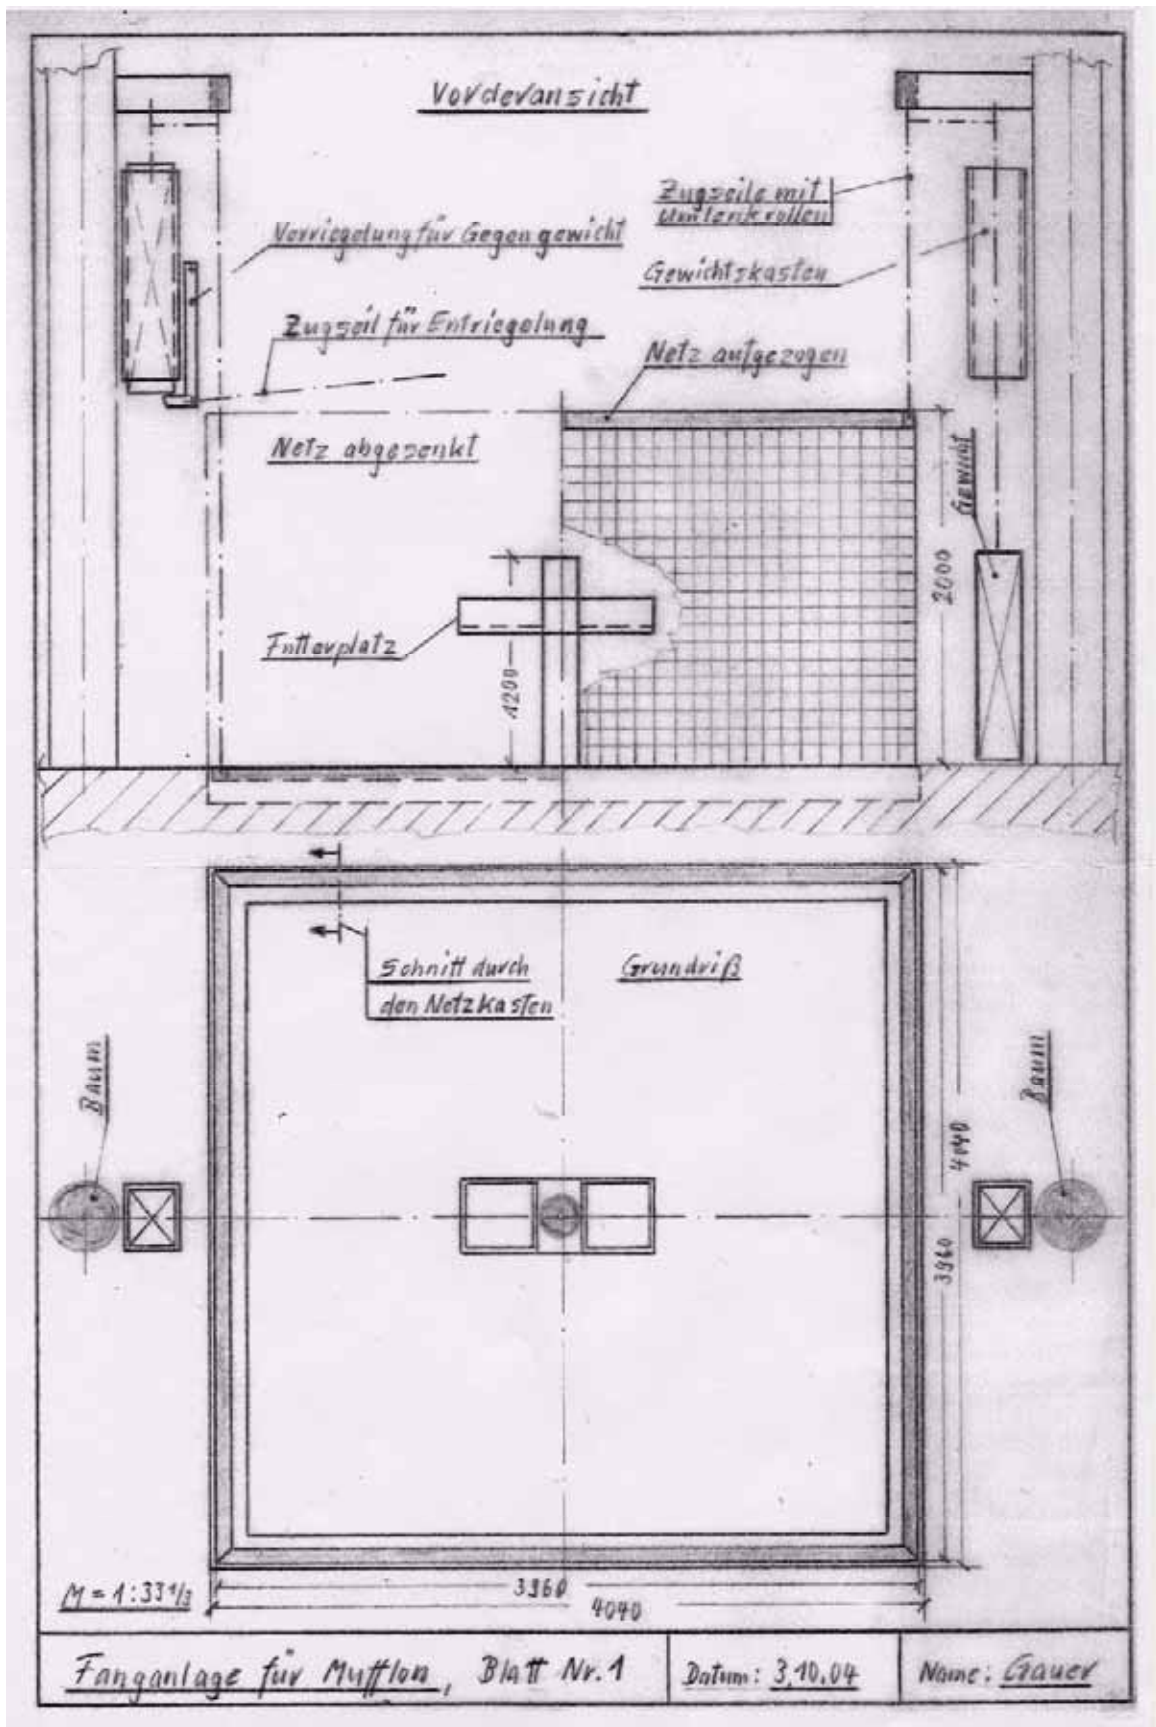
Planzeichnung 1 - Vorderansicht und Grundriss der Netzfanganlage (Albin Gauer, 10/04)
